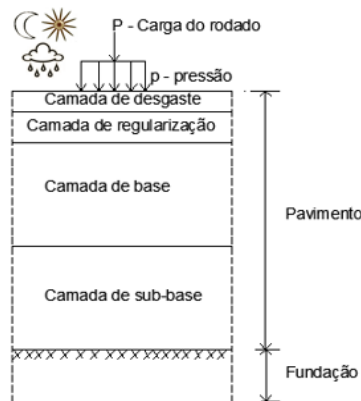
Constituição de uma estrutura tipo de um pavimento rodoviário e ações atuantes.
